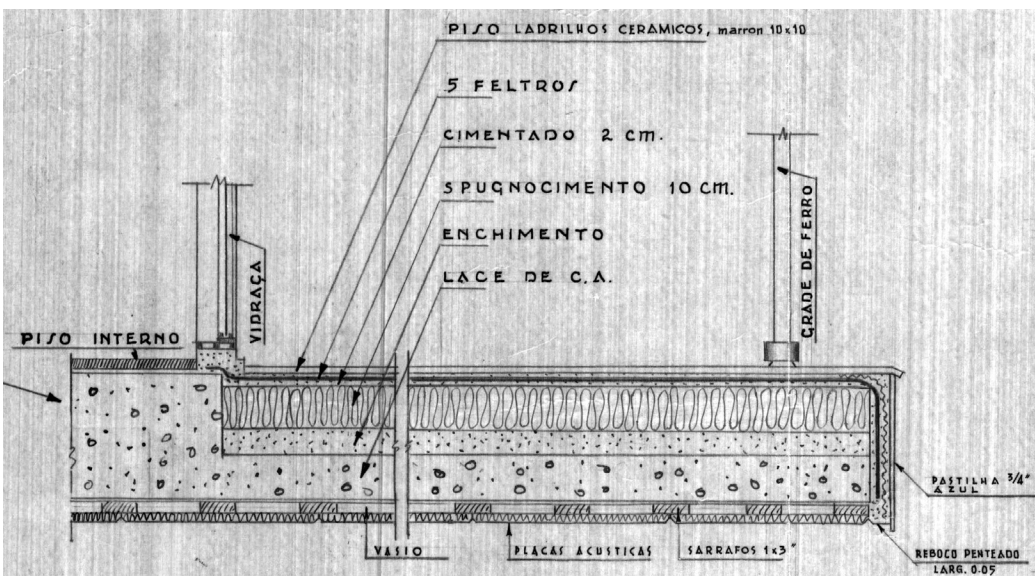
Projeto executivo original - Detalhe em corte da marquise superior
